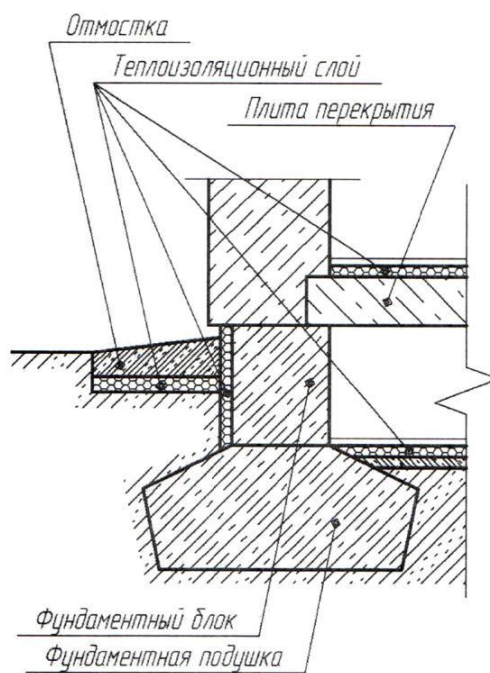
Конструкция утепления фундамента і підвалу
